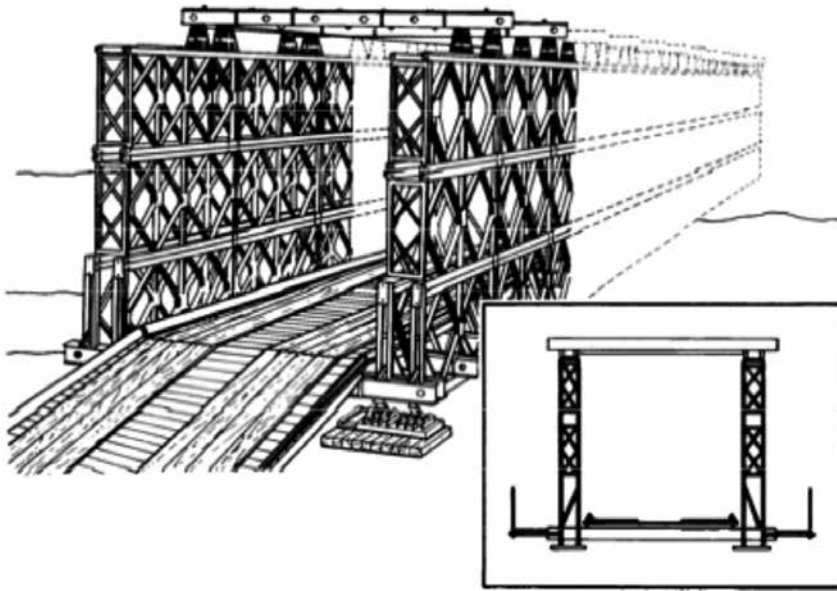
Schema prospettico di un ponte Bailey DT (*Double truss, Triple storey*) dello stesso tipo del *Lord Bridge* sul fiume Ronco (*Field manual Bailey Bridge; Headquarters Department of the Army, Washington DC, maggio 1986*)
